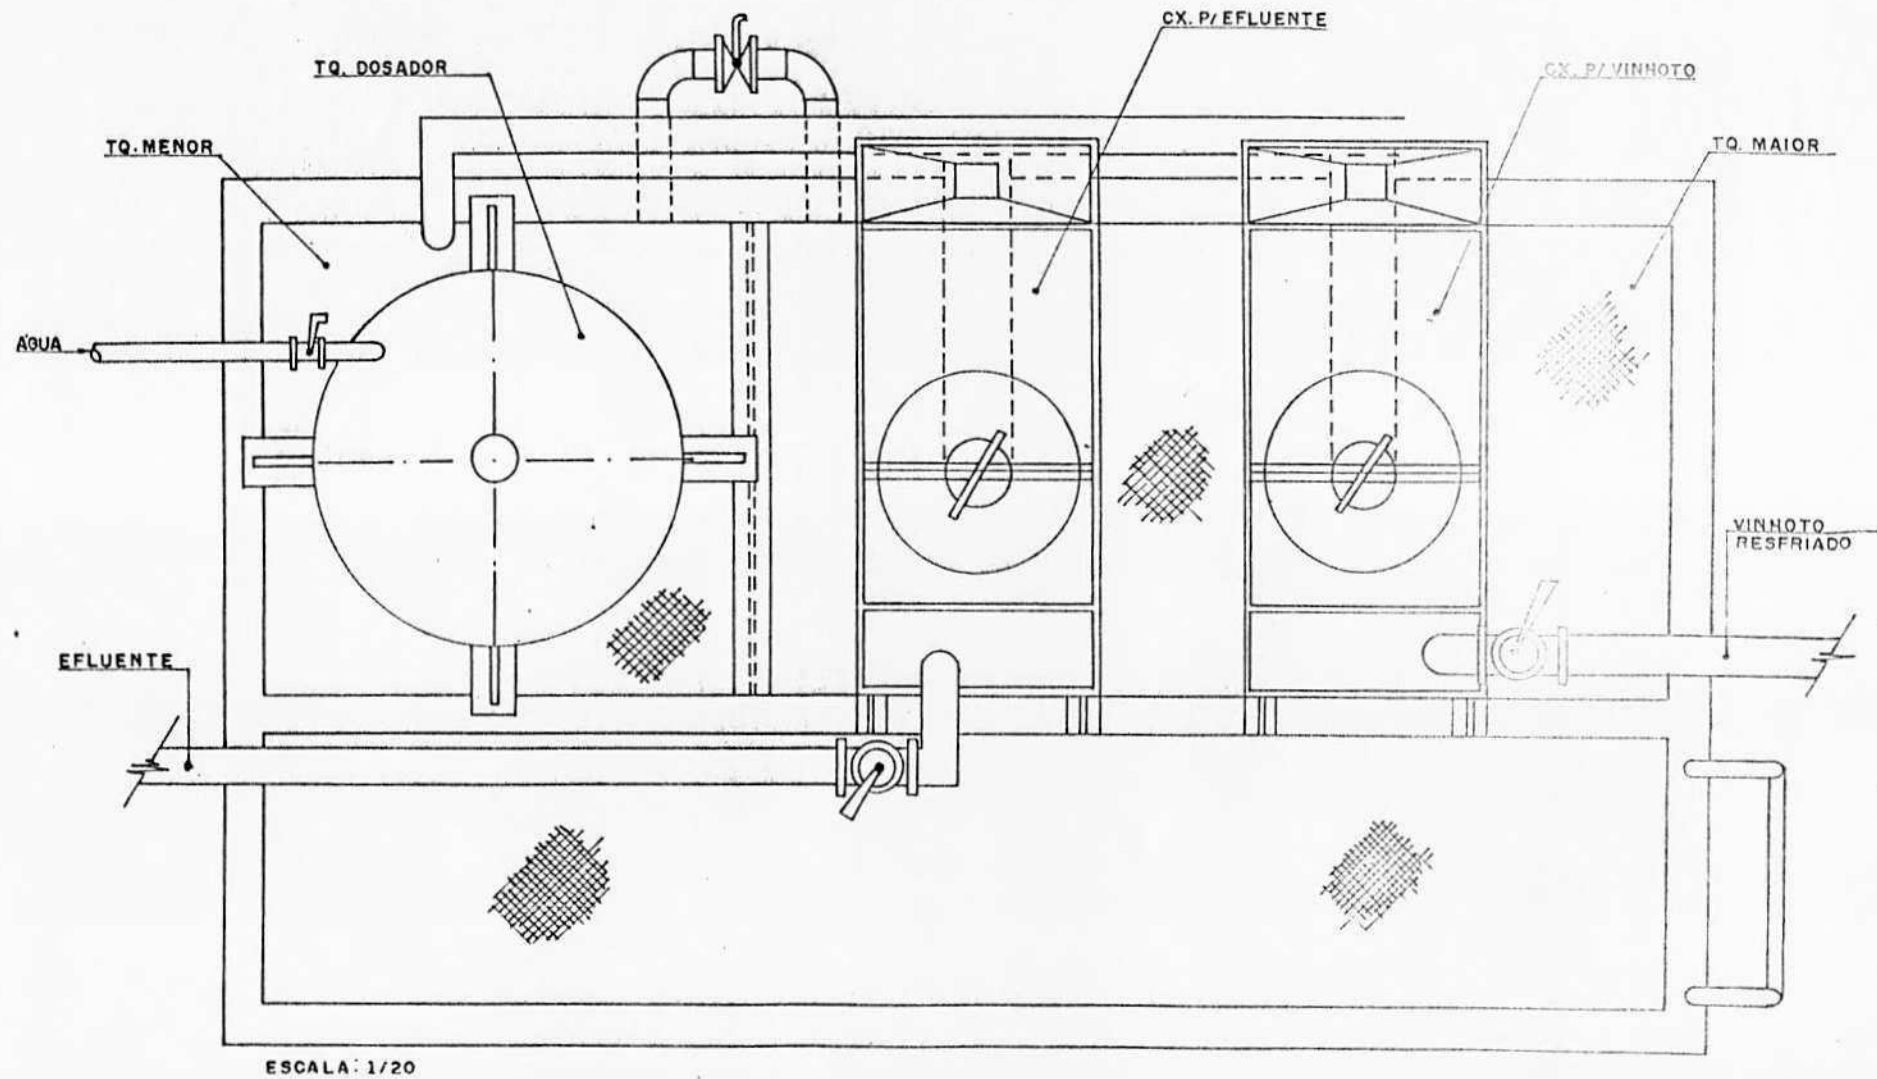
10- ESTRUTURA DE ENTRADA OU ALIMENTAÇÃO (PLANTA)
